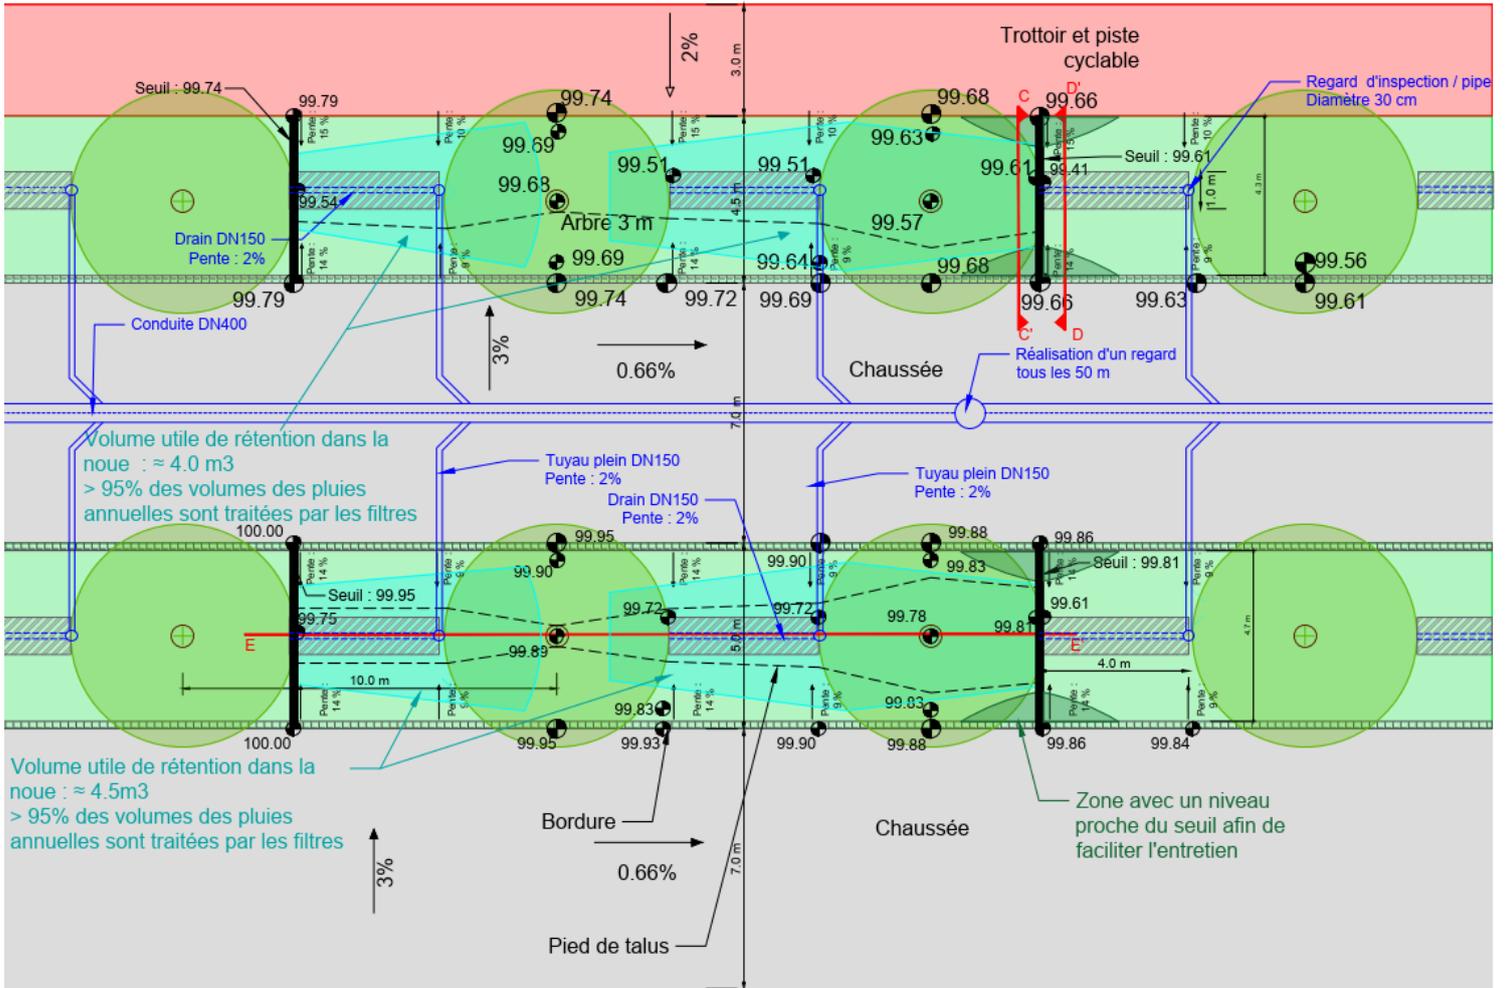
Schéma de fonctionnement hydraulique du système de gestion des eaux de chaussée - Plan de principe
